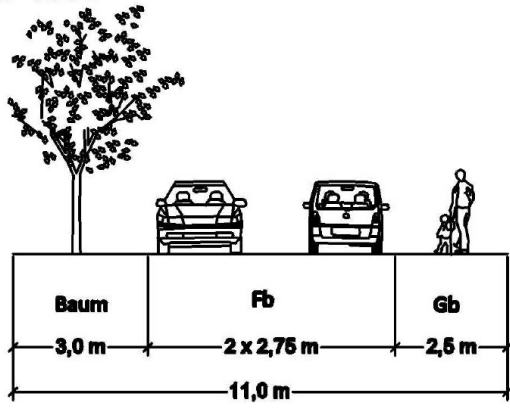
U-1814 im Bebauungsplan (©LHM)
